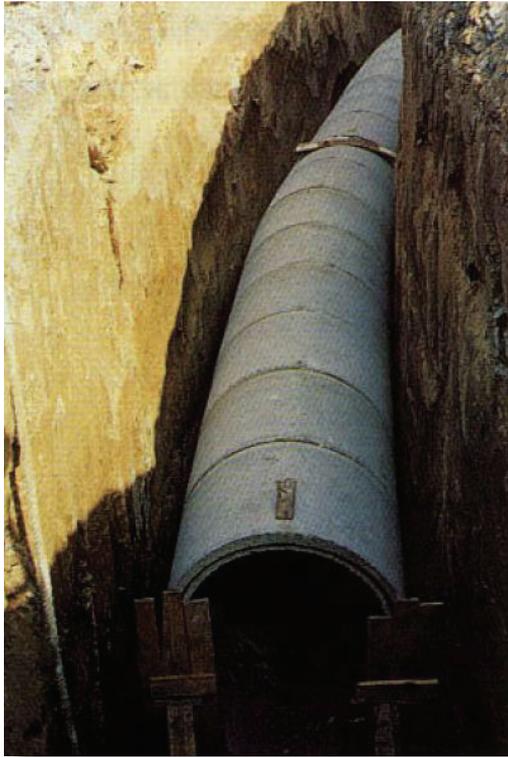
Espacio insuficiente entre la conducción y las paredes de la zanja, haciendo imposible la compactación por debajo del plano medio
